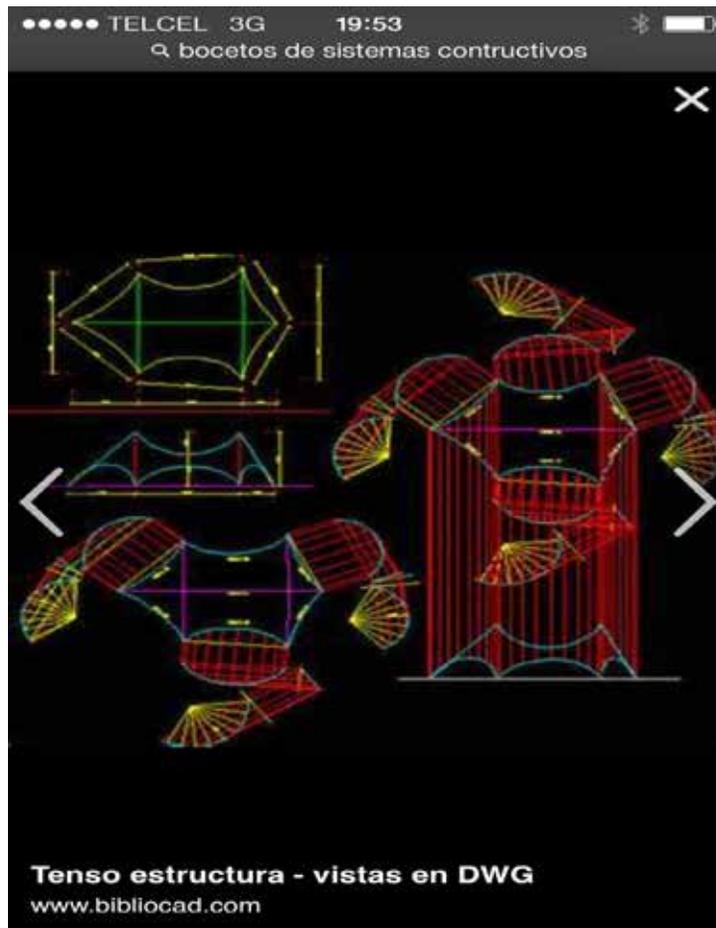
Boceto de sistemas constructivos en una Tenso estructura. Fuente: www.bibliocad.com
